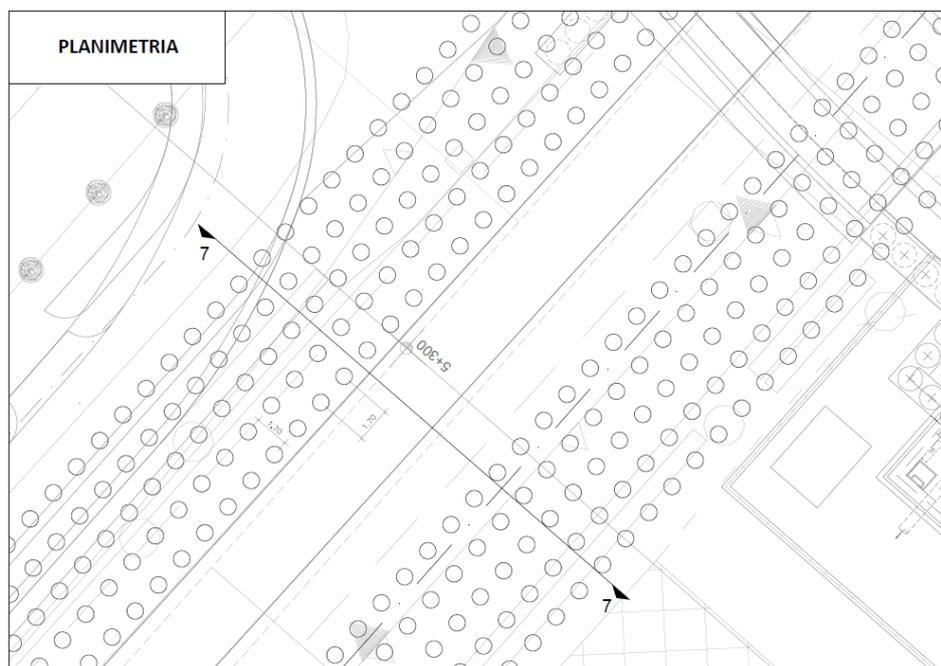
Sezione rappresentativa tratta 5+100 – 5+400 - planimetria
